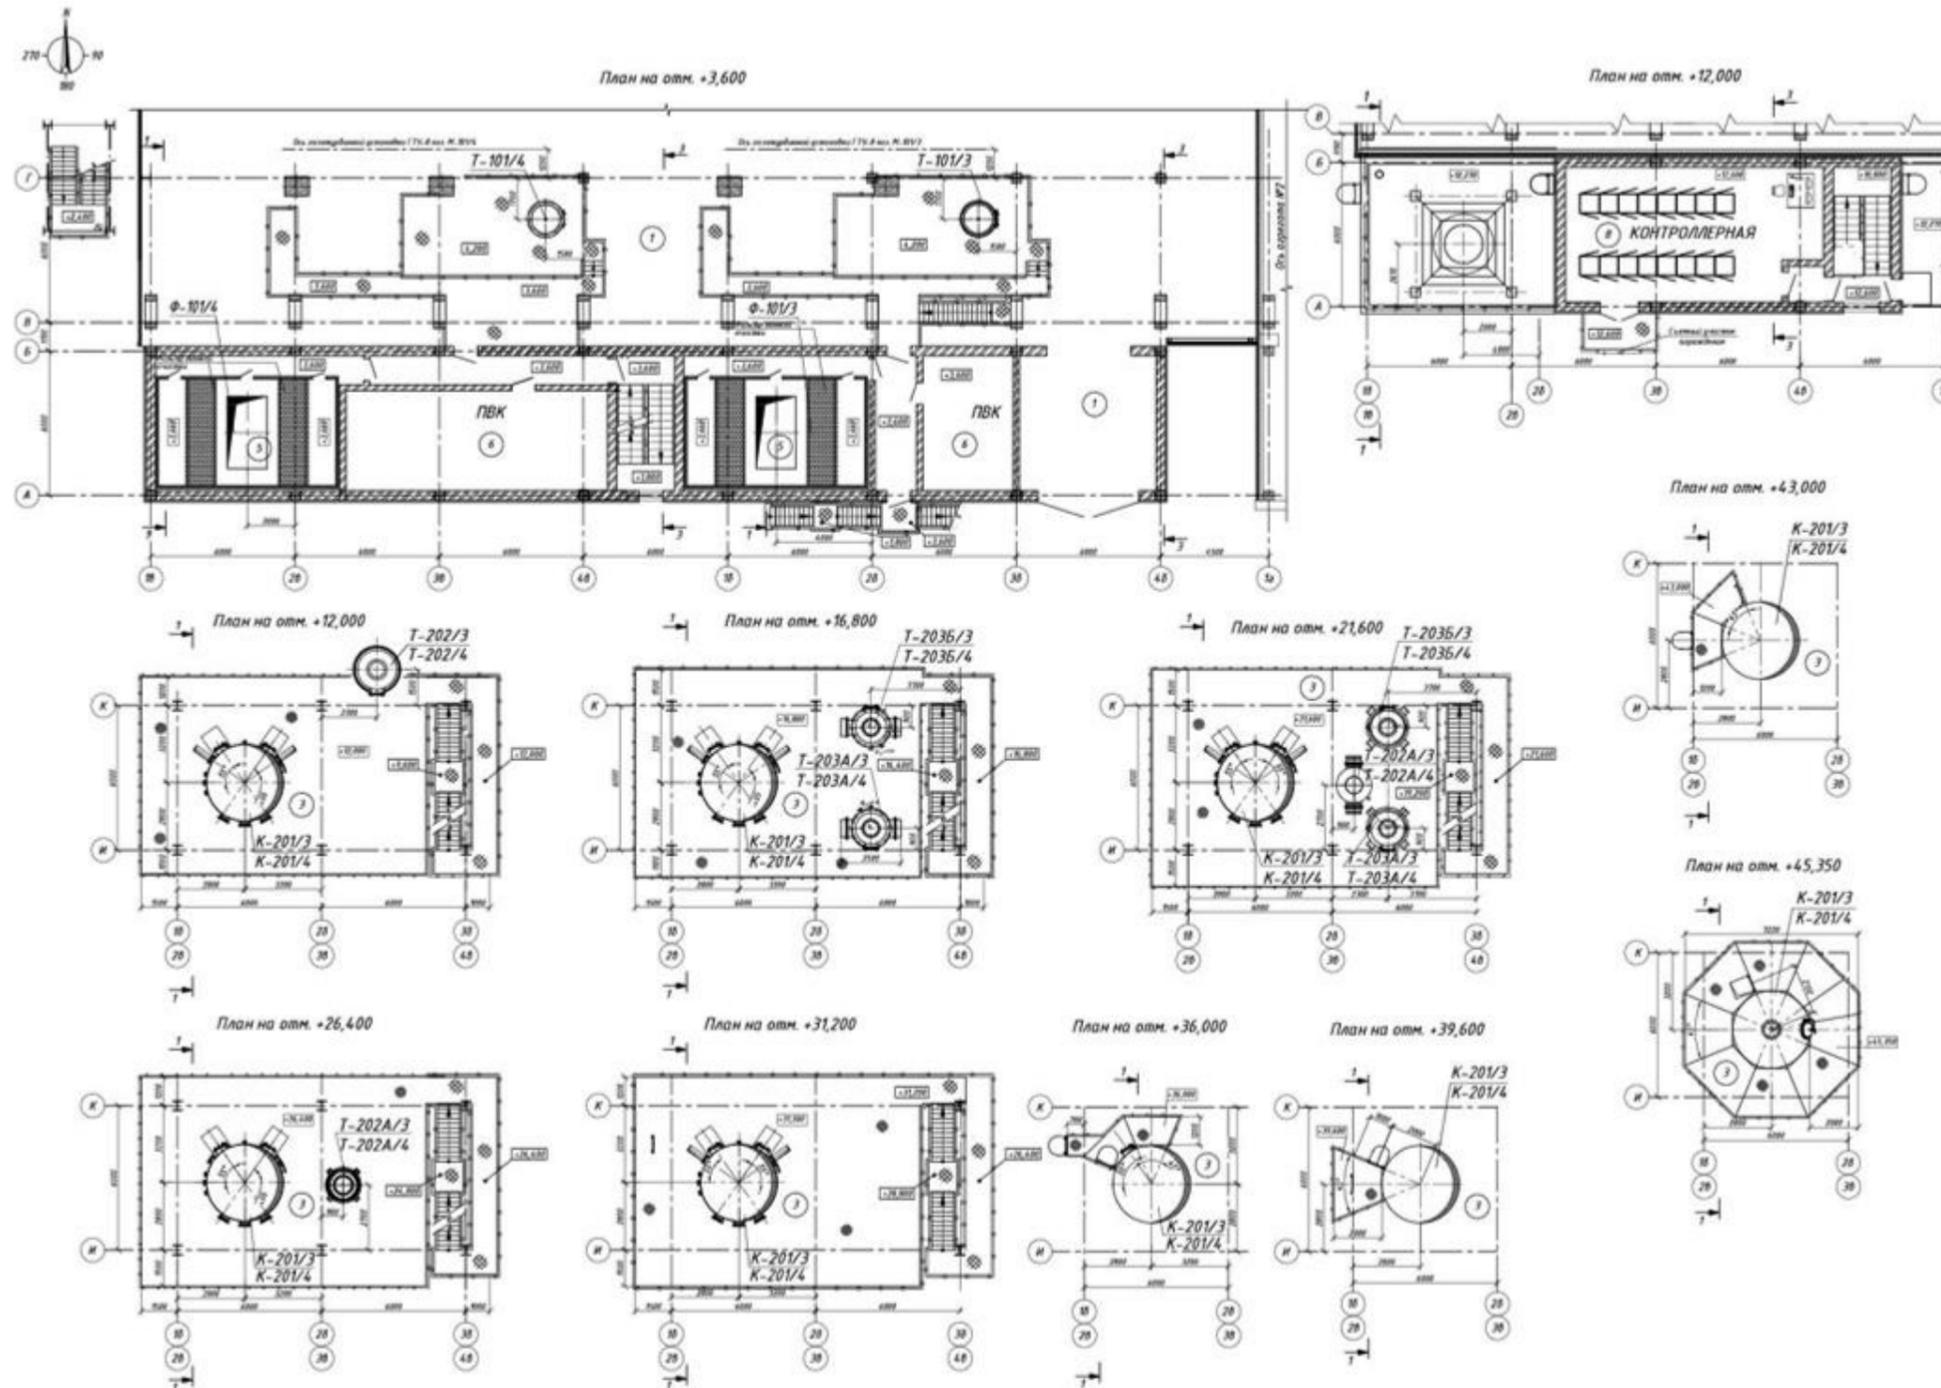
План размещения основного технологического оборудования корпус 5026. Планы на отм. +3,600, +12,000, +16,800, +21,600, +26,400, +31,200, +36,000, +39,600, +43,000, +45,350 м
